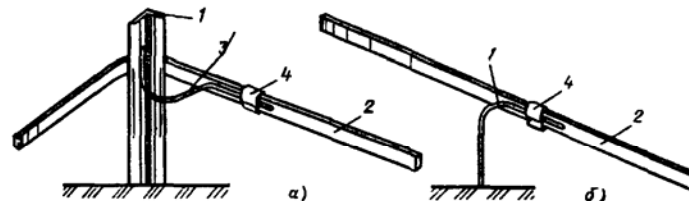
Соединение плоского горизонтального заземлителя с электродом термитной сваркой:
